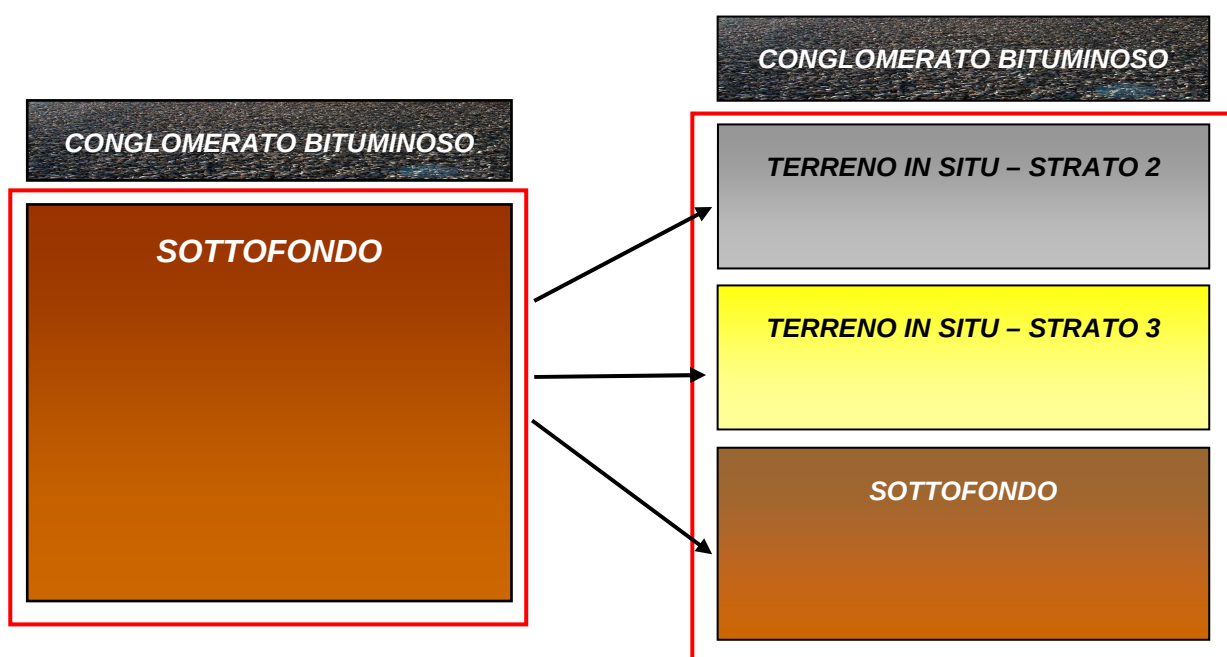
trasformazione della sezione reale nella sezione di calcolo
